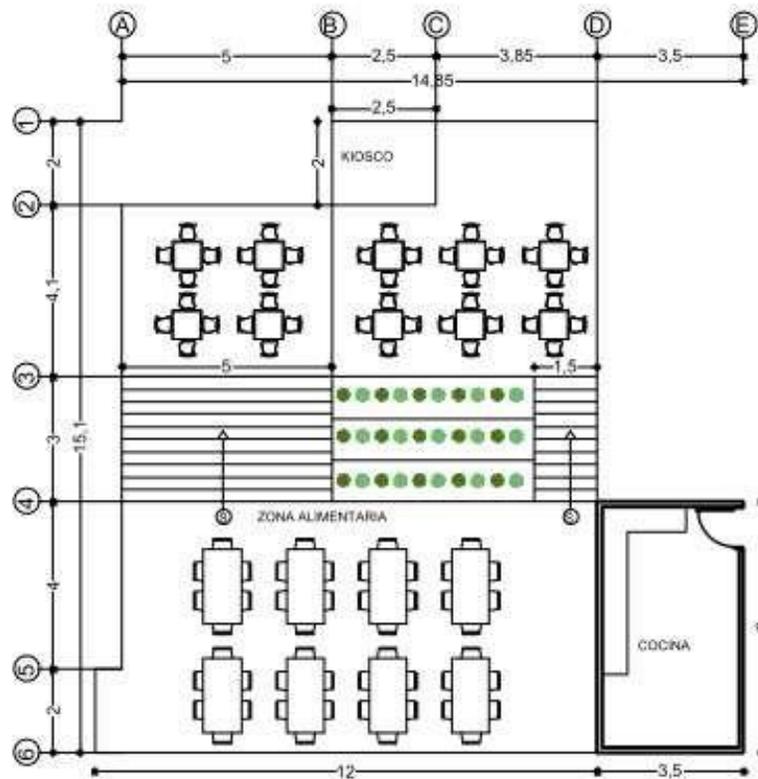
Plano Restaurante "El Campano" - Fuente: Elaboración propia.
